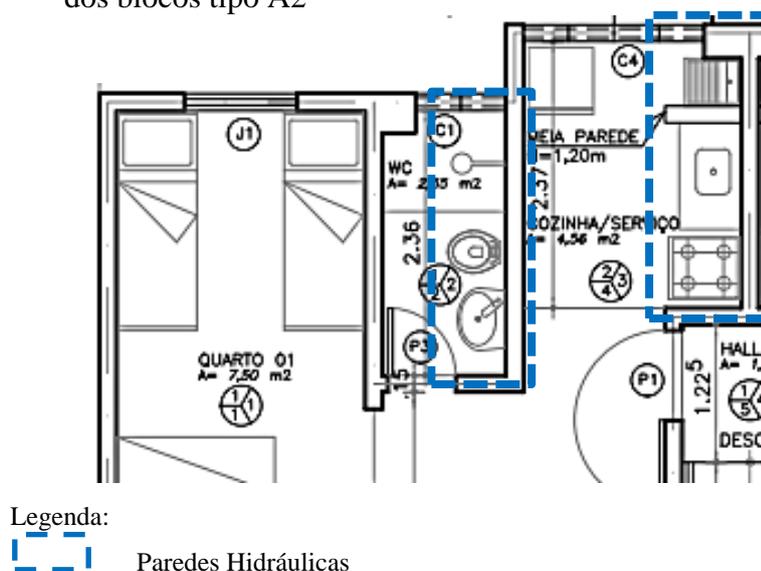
Zoneamento da planta do pavimento superior do bloco tipo A2
